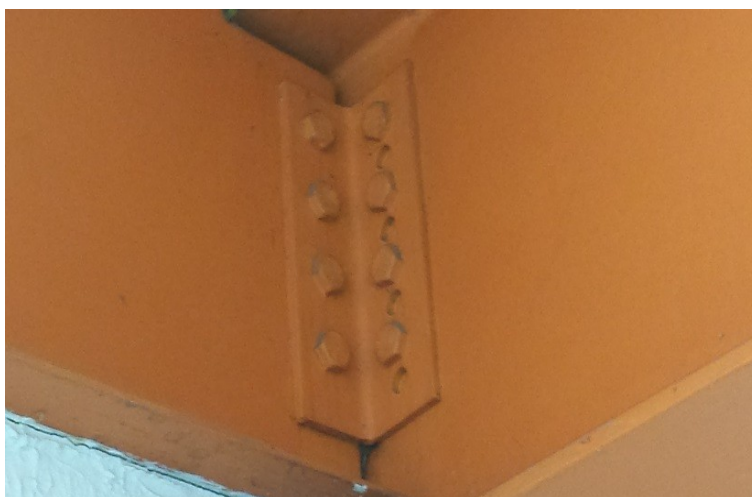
Viga do pavimento tipo do bloco F. Ver item 2.16.1.3.2 Fonte: Autor
